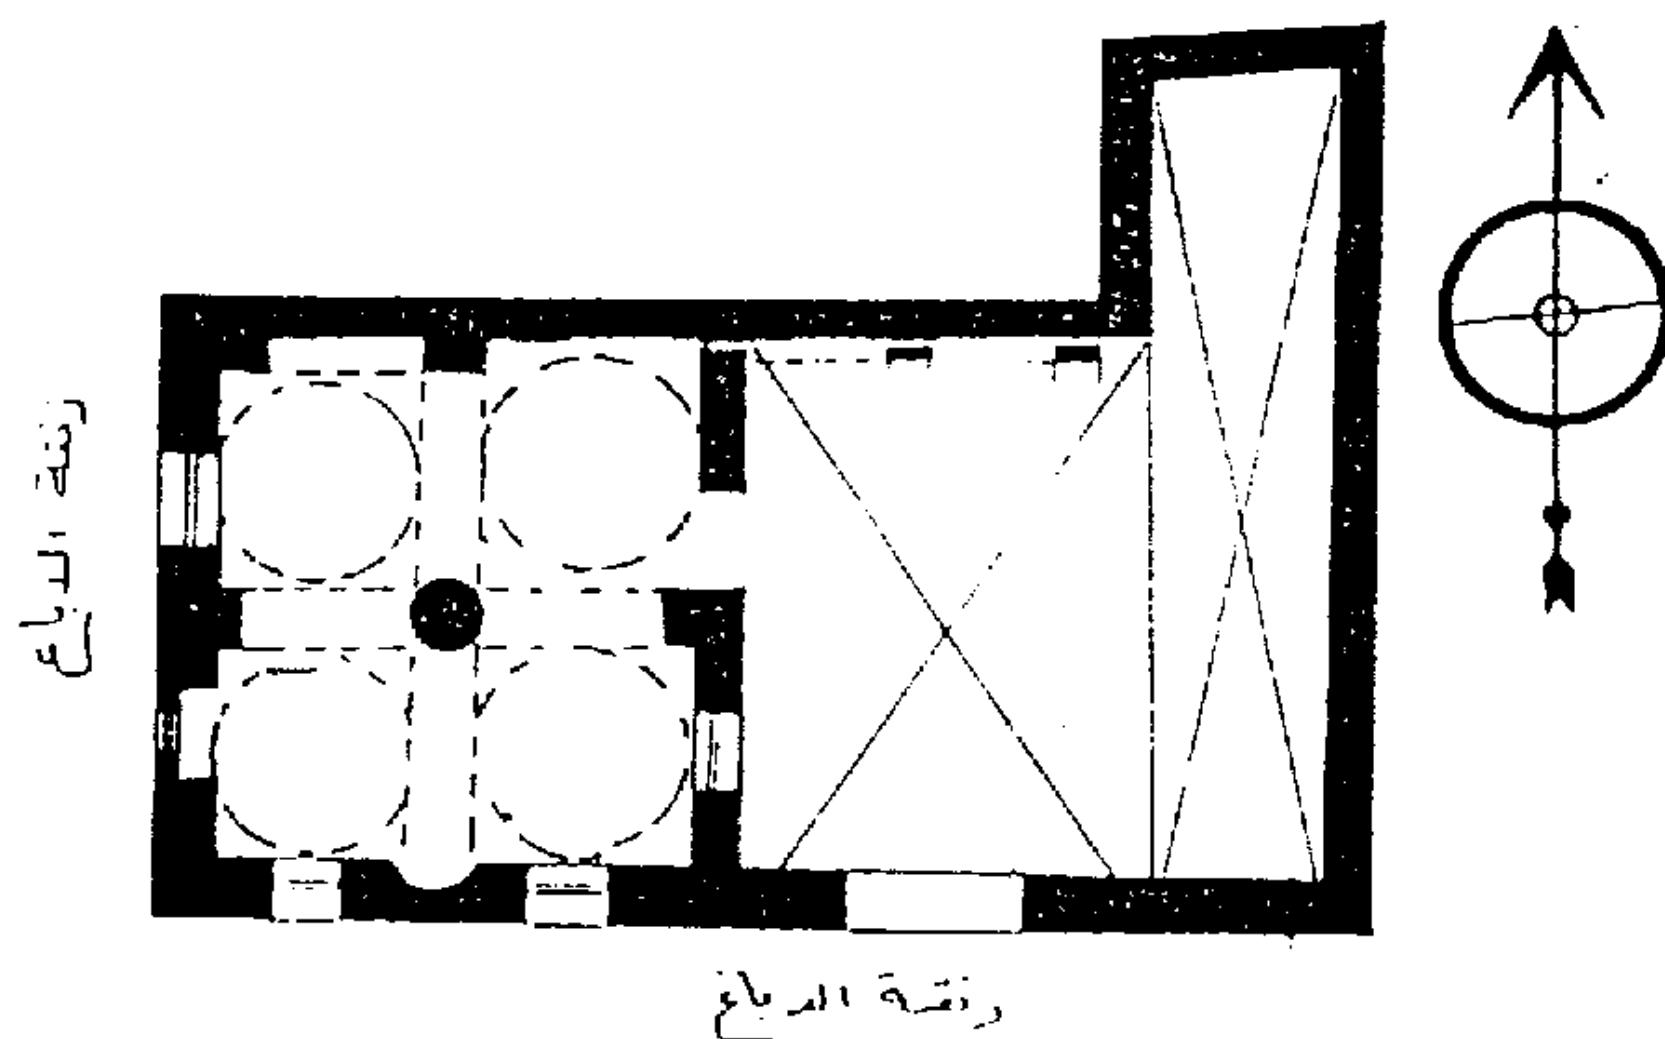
مسقط أفقي لمسجد كولوك عن أصلان آبا.
